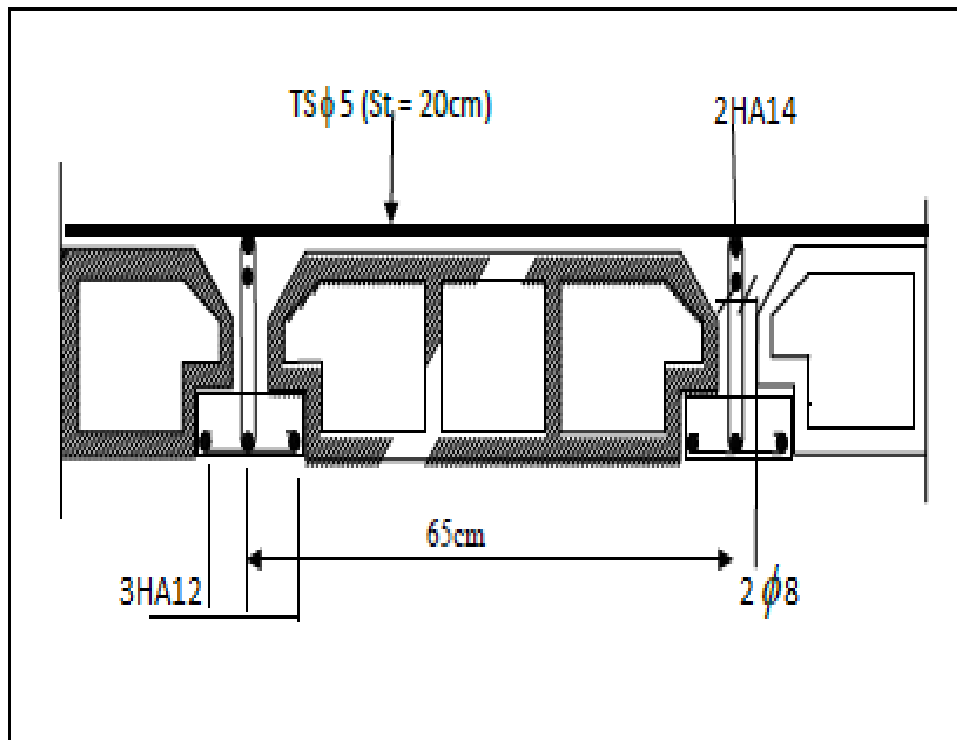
Plan de ferrailage du plancher s-sol en corps creux.
